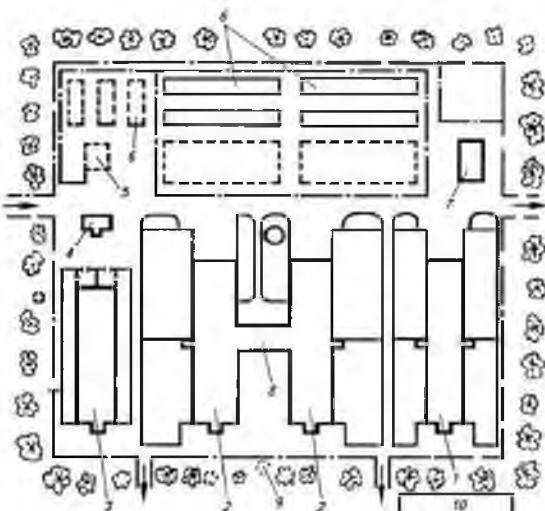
Генеральный план фермы на 400 коров привязанного содержания:
